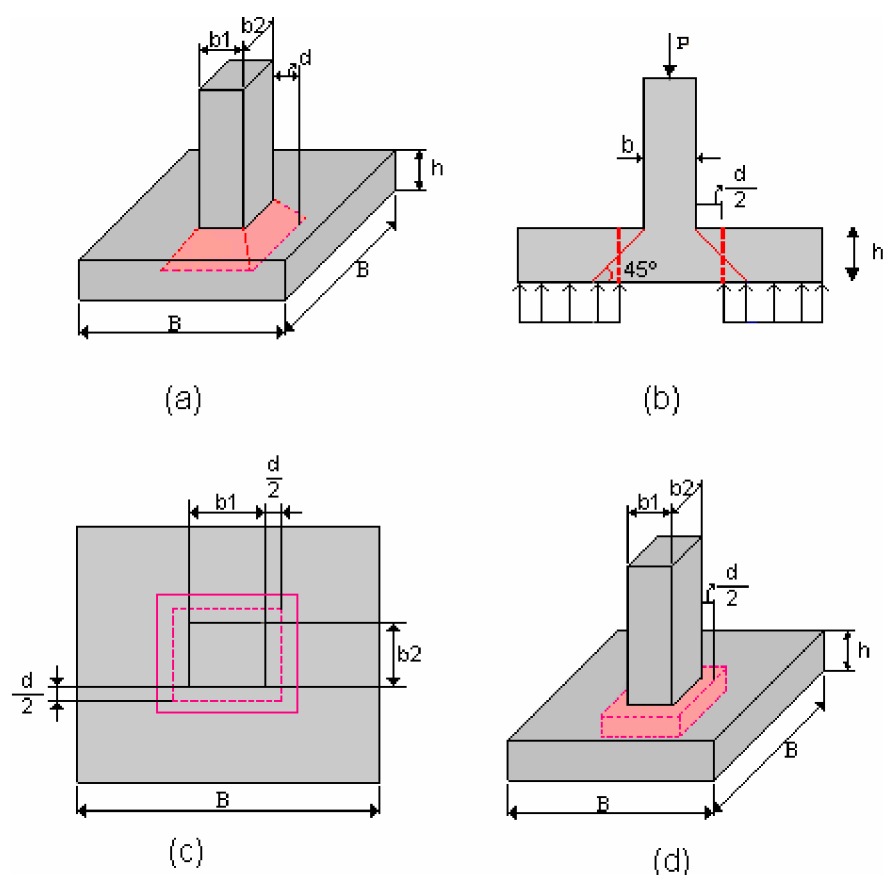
Cortante bidireccional en zapata que soporta columna, pedestal o muro de concreto.
